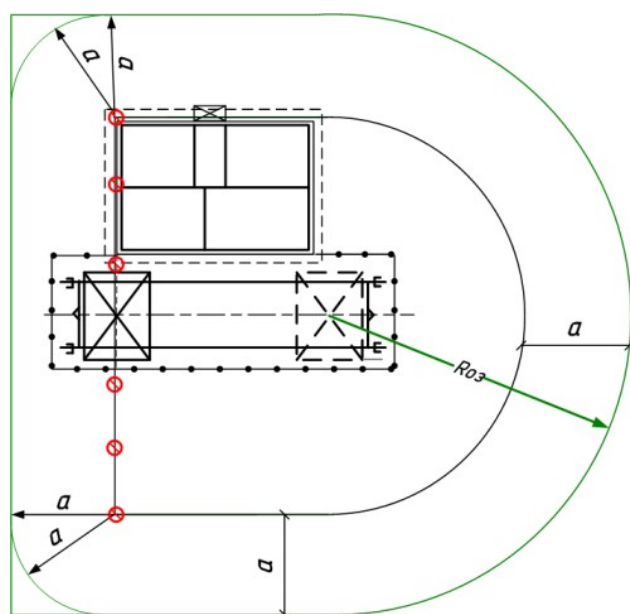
Схема к определению опасной зоны работы крана
